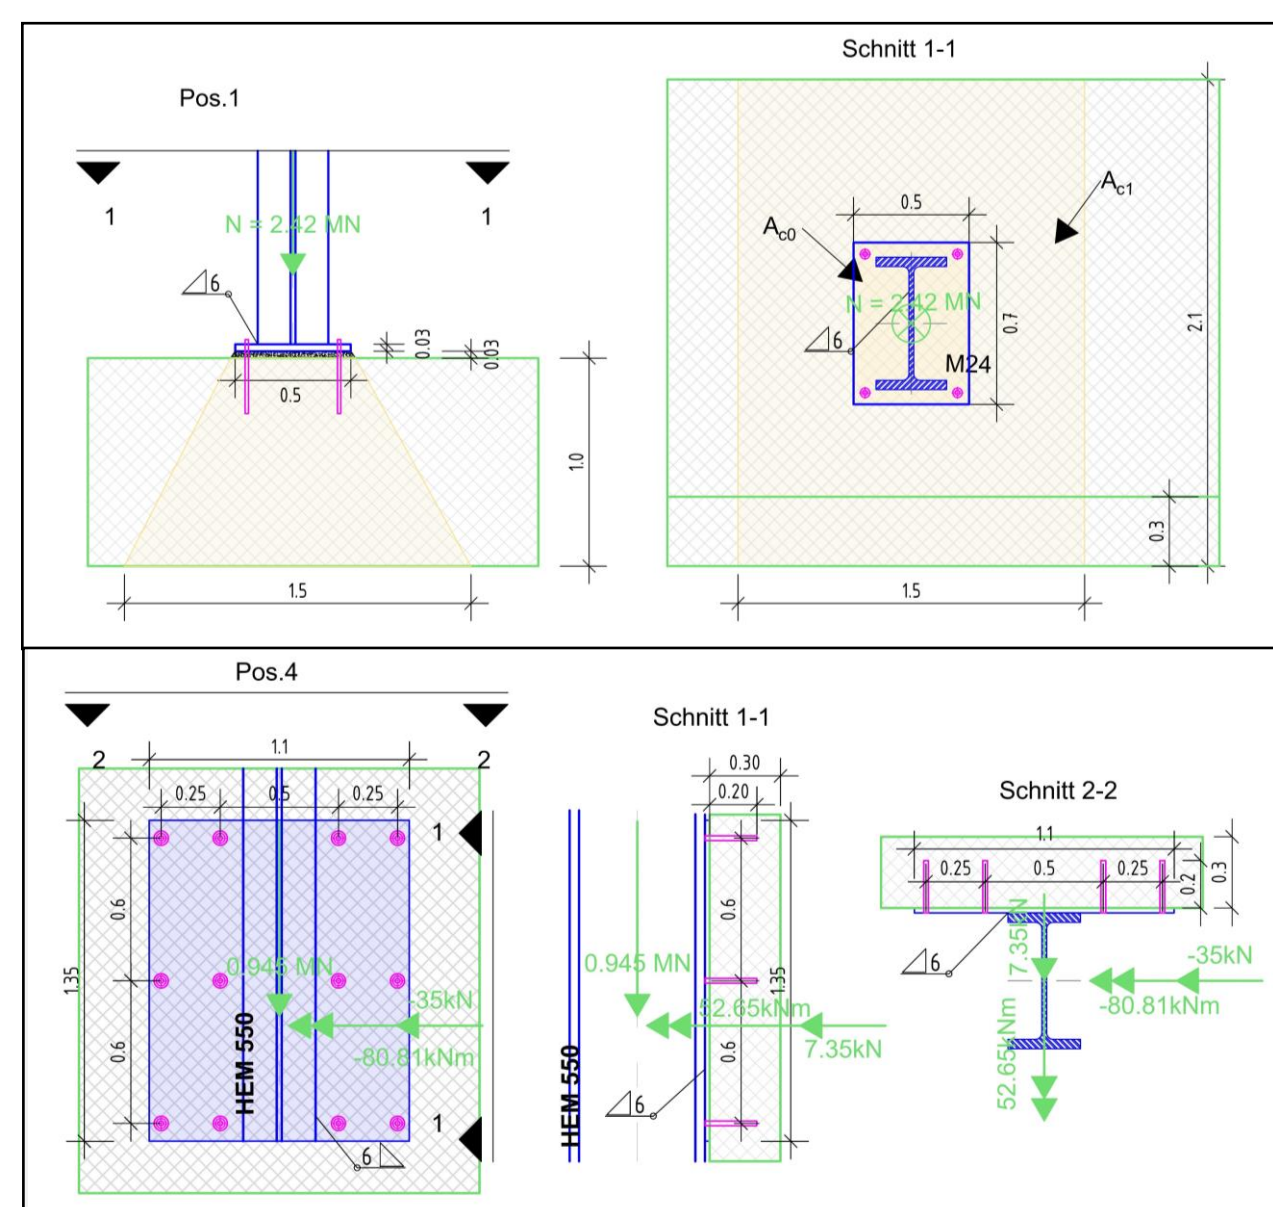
Pos.1. Lastausbreitung im Druckauflagerbereich & Pos.4. Verankerung der Zugkraft in der Stahlbetonwand
